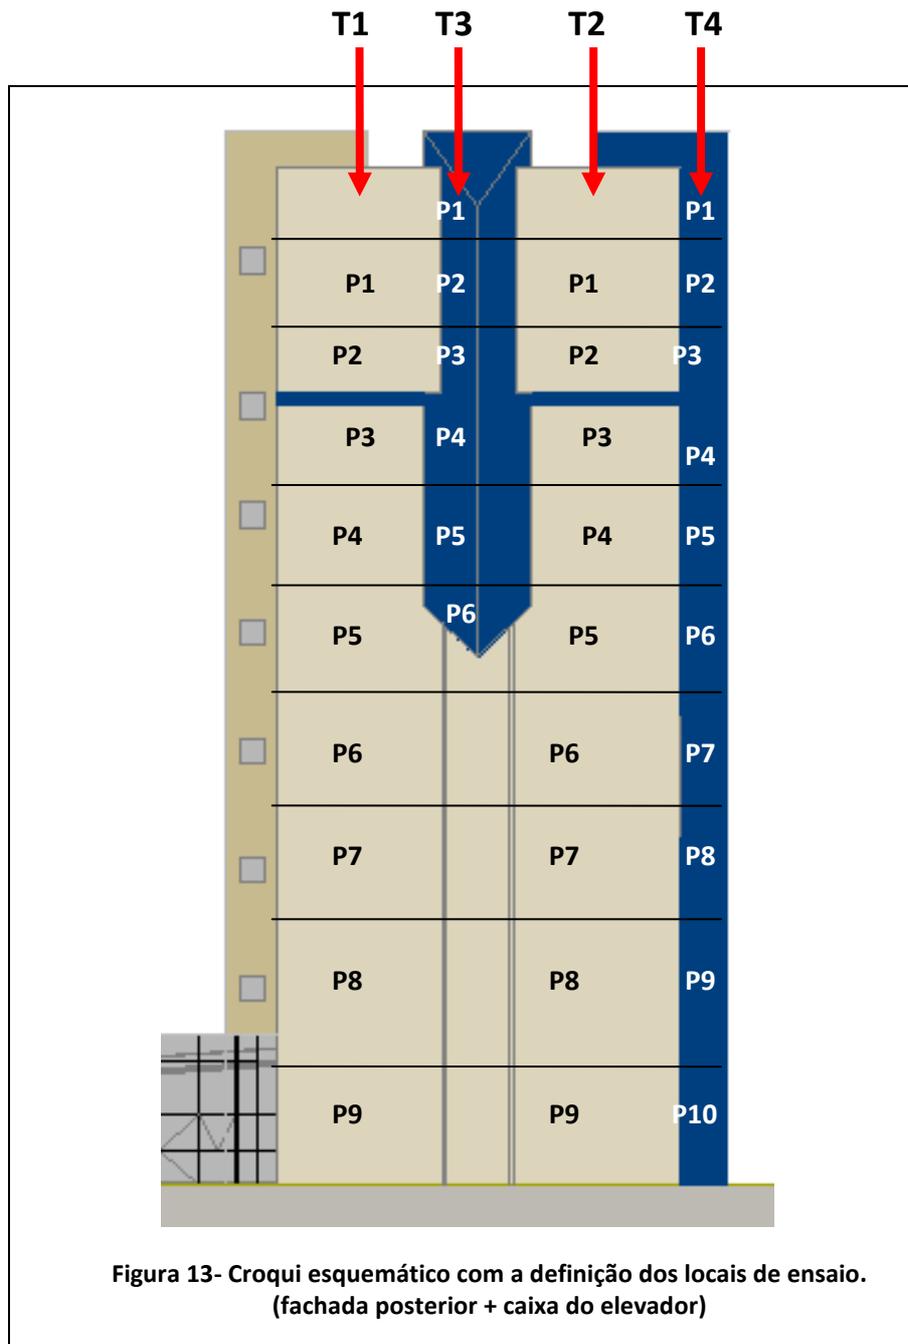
Croqui esquemático com a definição dos locais de ensaio.
